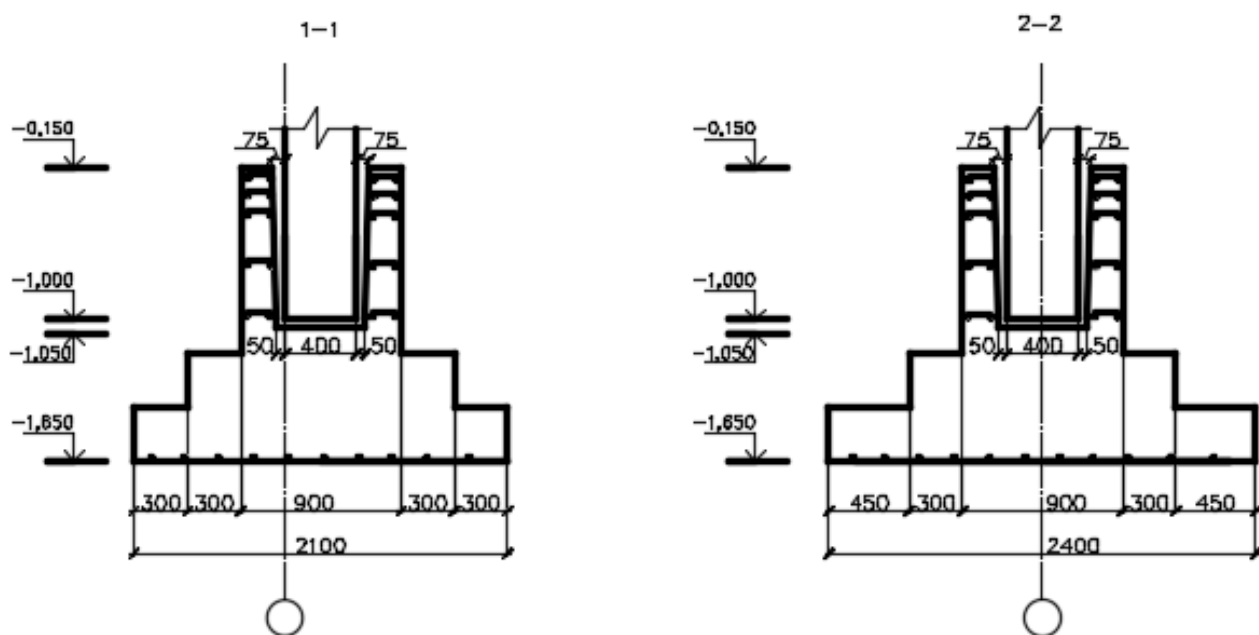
Схема к расчету арматуры плитной части фундамента
